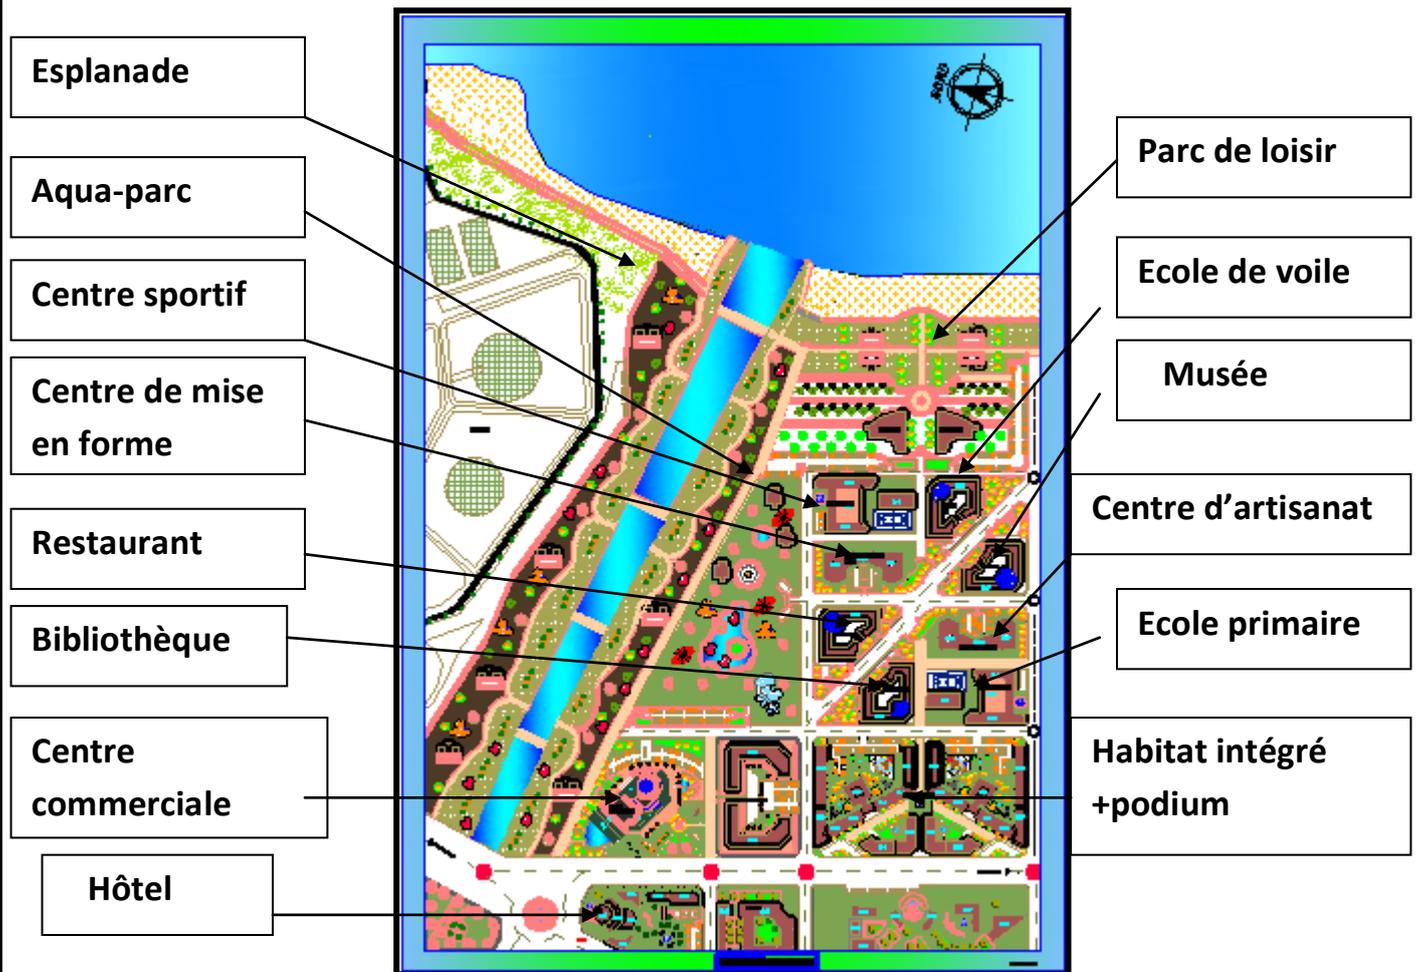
Le mimi plan d'aménagement Source : auteurs
